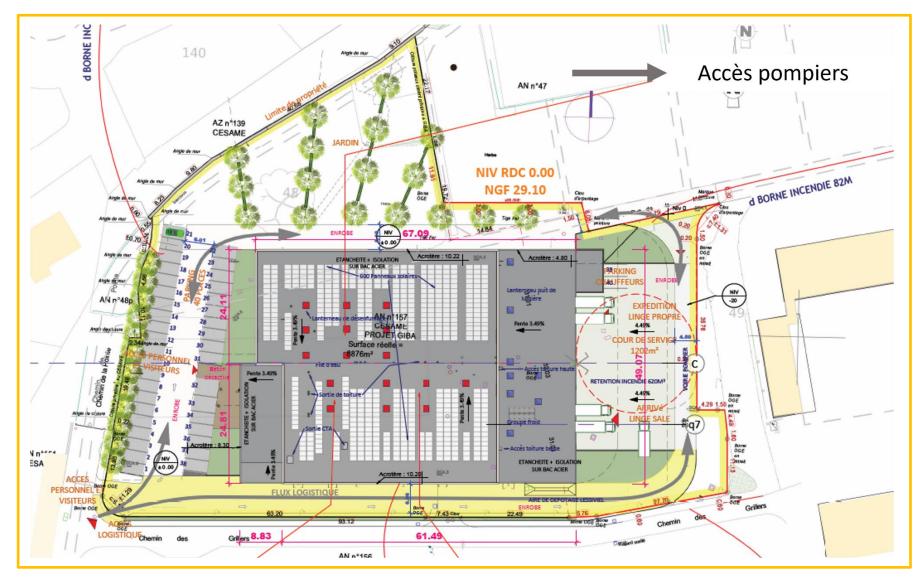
Accessibilité du site (source groupement BOISSEAU)
